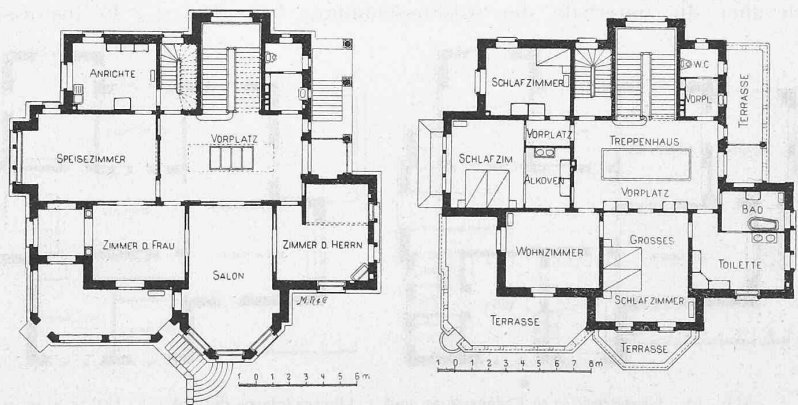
Grundrisse vom Erdgeschoss und I. Obergeschoss der Villa Baumann in Zürich II. — Masstab 1:400.
